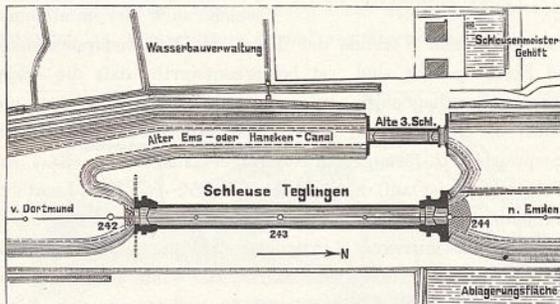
Lageplan der Schleuse bei Teglingen. 1:4000.
